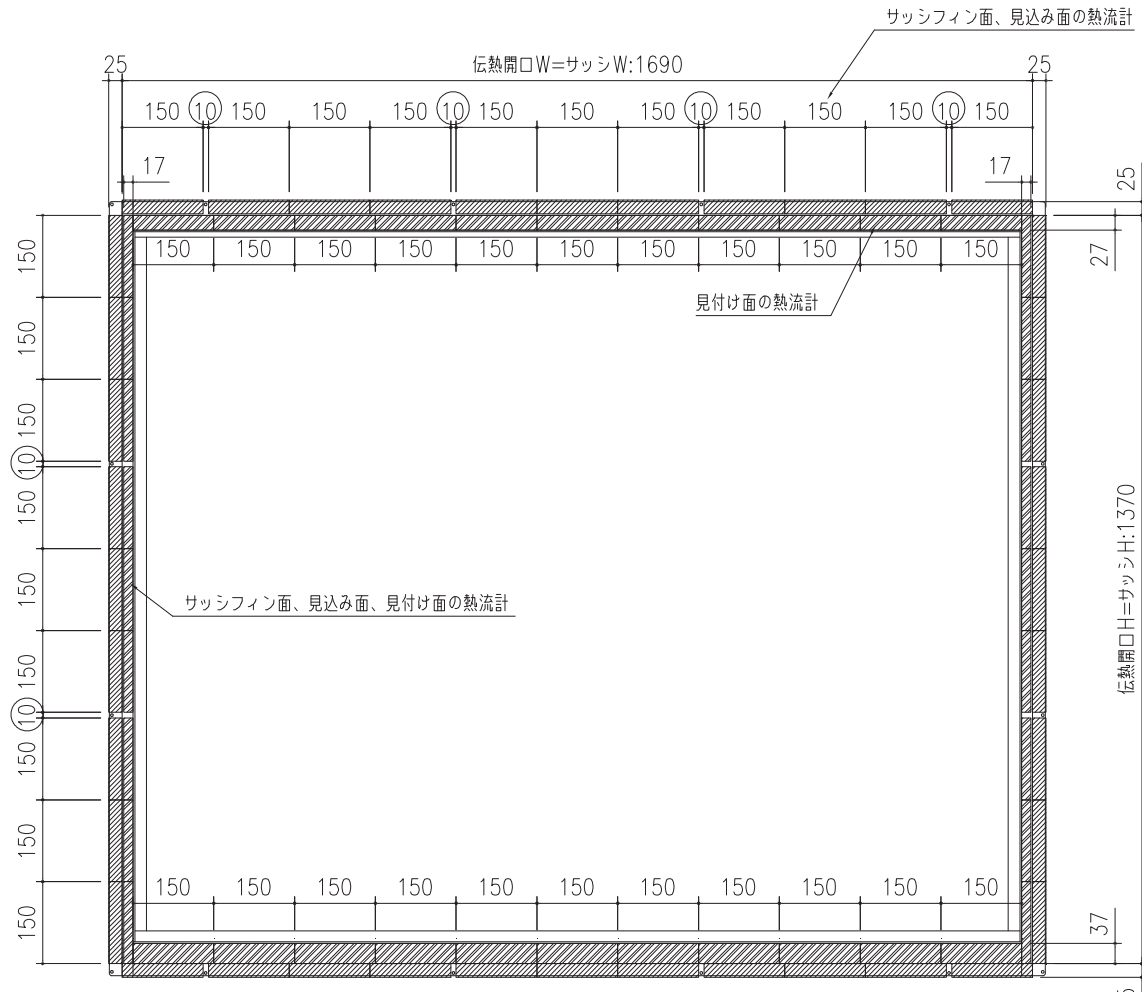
窓フレーム周りの熱流計配置図
